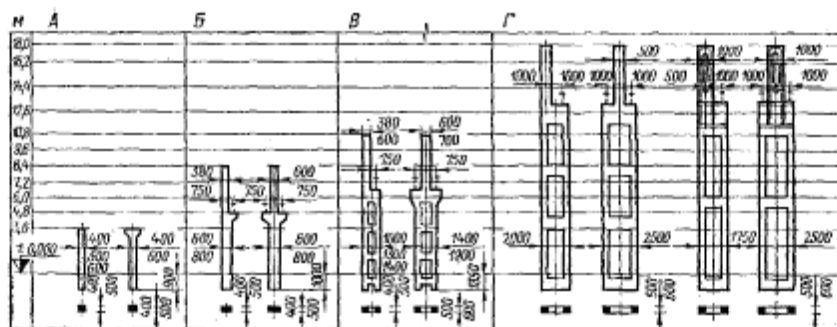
Типовые унифицированные сборные железобетонные колонны (кратно 1,2 м; свыше 10,6 м – кратно 1,8 м). А – колонны для бескрановых пролетов; Б – для кранов грузоподъемностью 10 и 20 т; В – для кранов грузоподъемностью 10, 20, 30, 50 т; Г – колонны специального назначения для кранов с тяжелым режимом работы.
